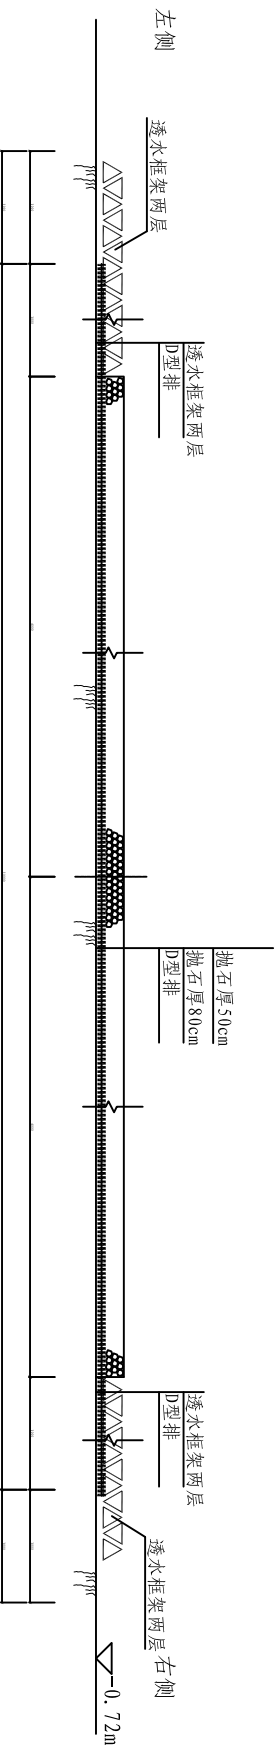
安庆河段航道整治二期工程方案二平面布置图
